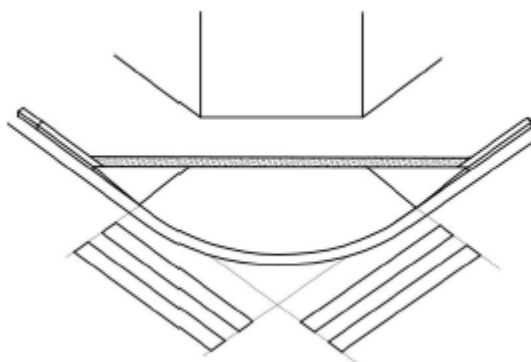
Rebaixamento do lancil junto às esquinas
